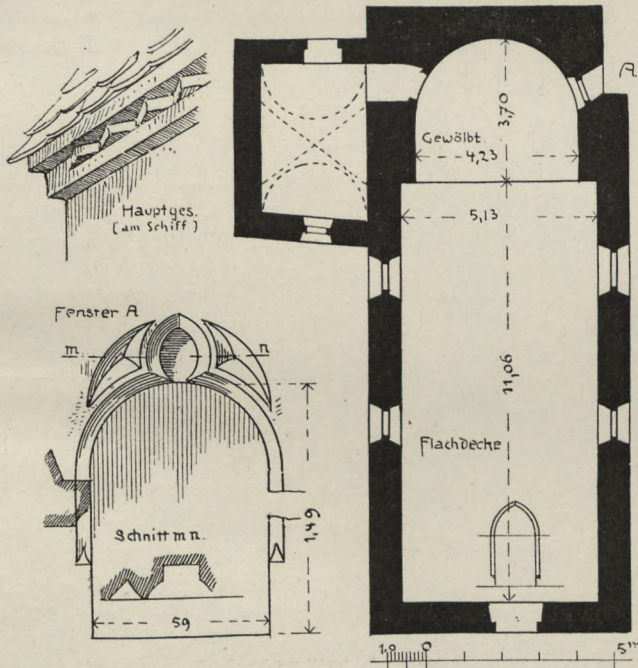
Brudersdorf. Kirche. Grundriß und Details.
